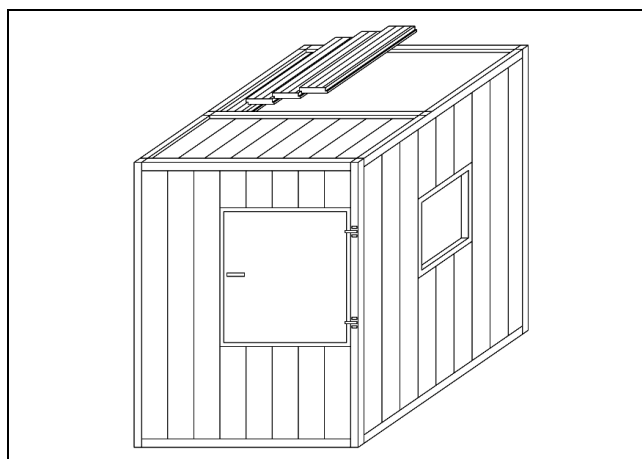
Esempio di copertura ad elevato potere fonoisolante
